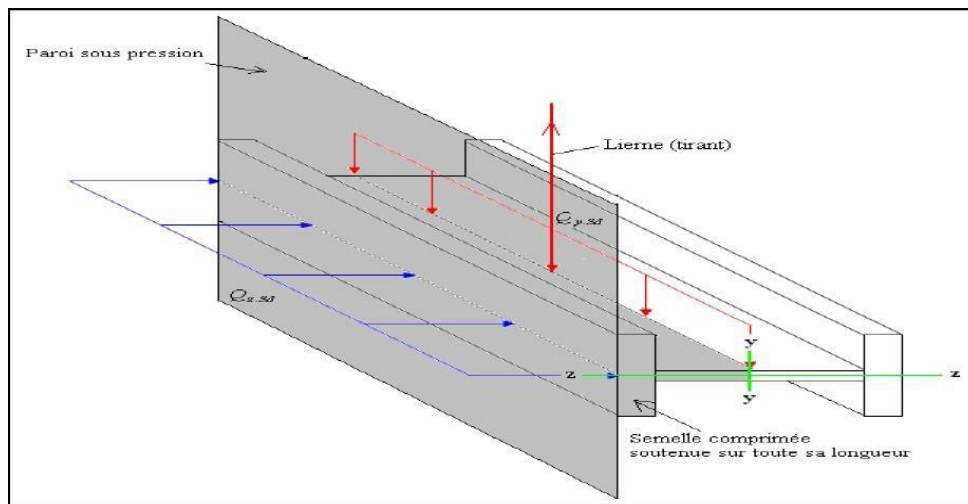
Semelle comprimée soutenue sur toute sa longueur.
